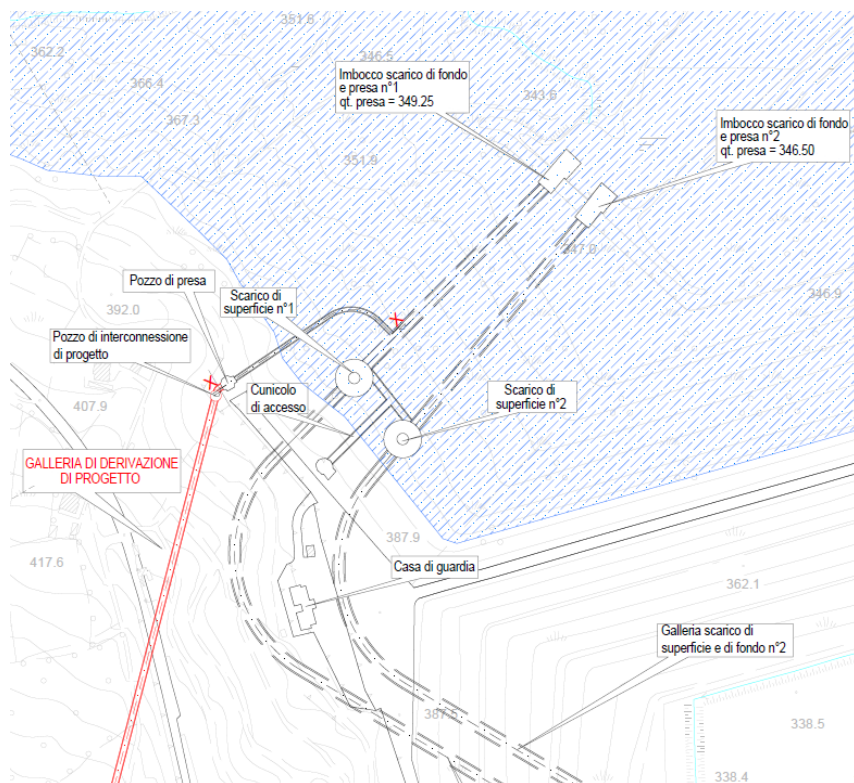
Planimetria di dettaglio del nuovo manufatto di interconnessione
